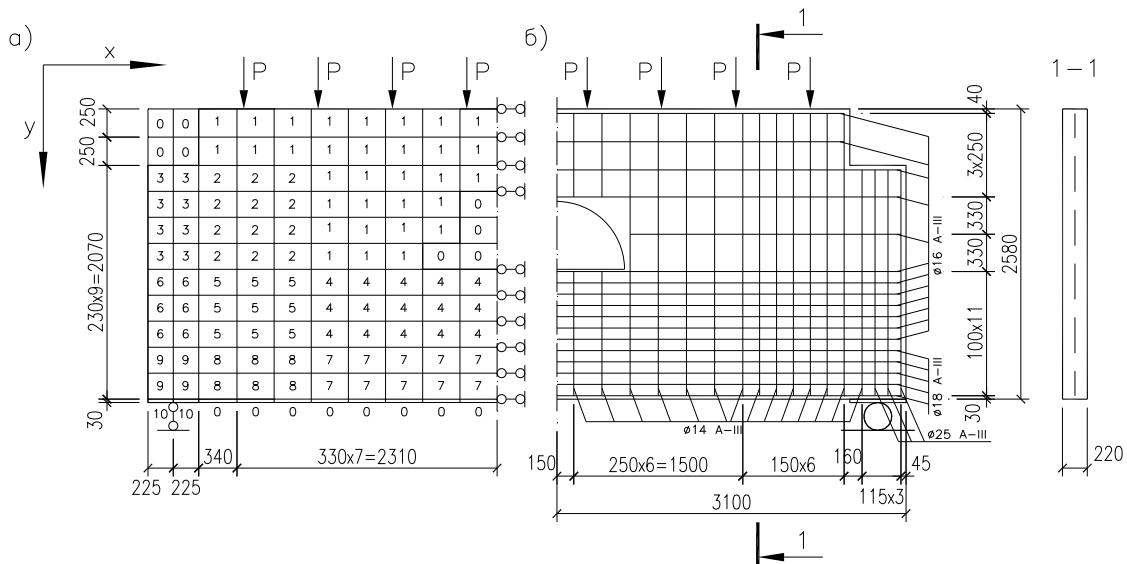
а) нумерация типов жесткостей; б) армирование балок-стенок БС-1, БС-2, БС-3
